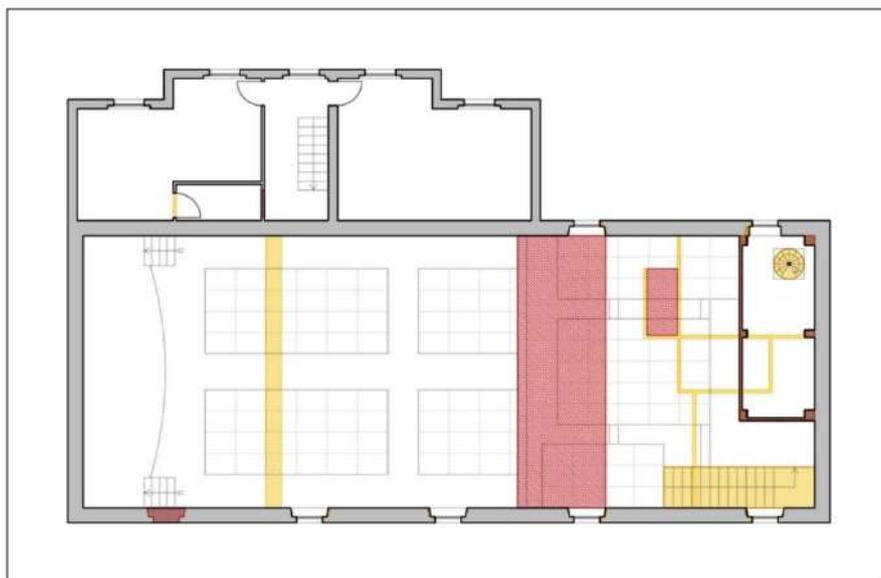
Pianta Piano Primo, Stato Sovrapposto, 1979, 2° Progetto con struttura in c.a.
